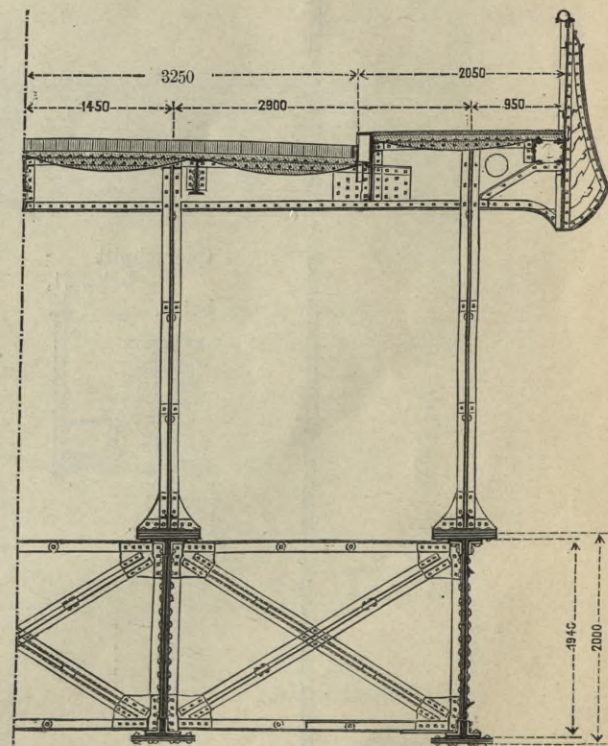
Mittelöffnung. Querschnitt im Punkte 9.
